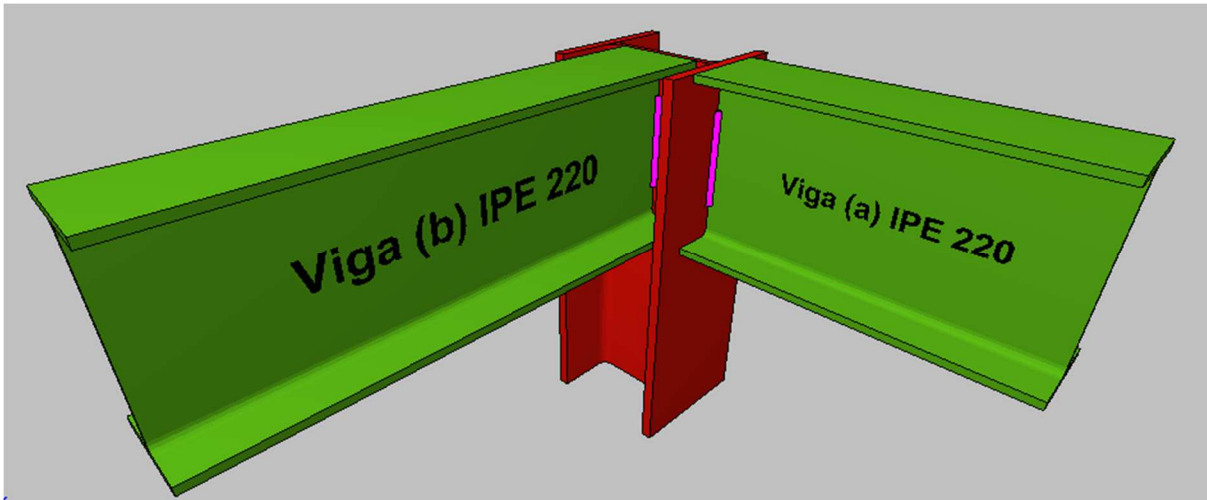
Unión tipo 3 soporte superior. Viga-pilar-viga
